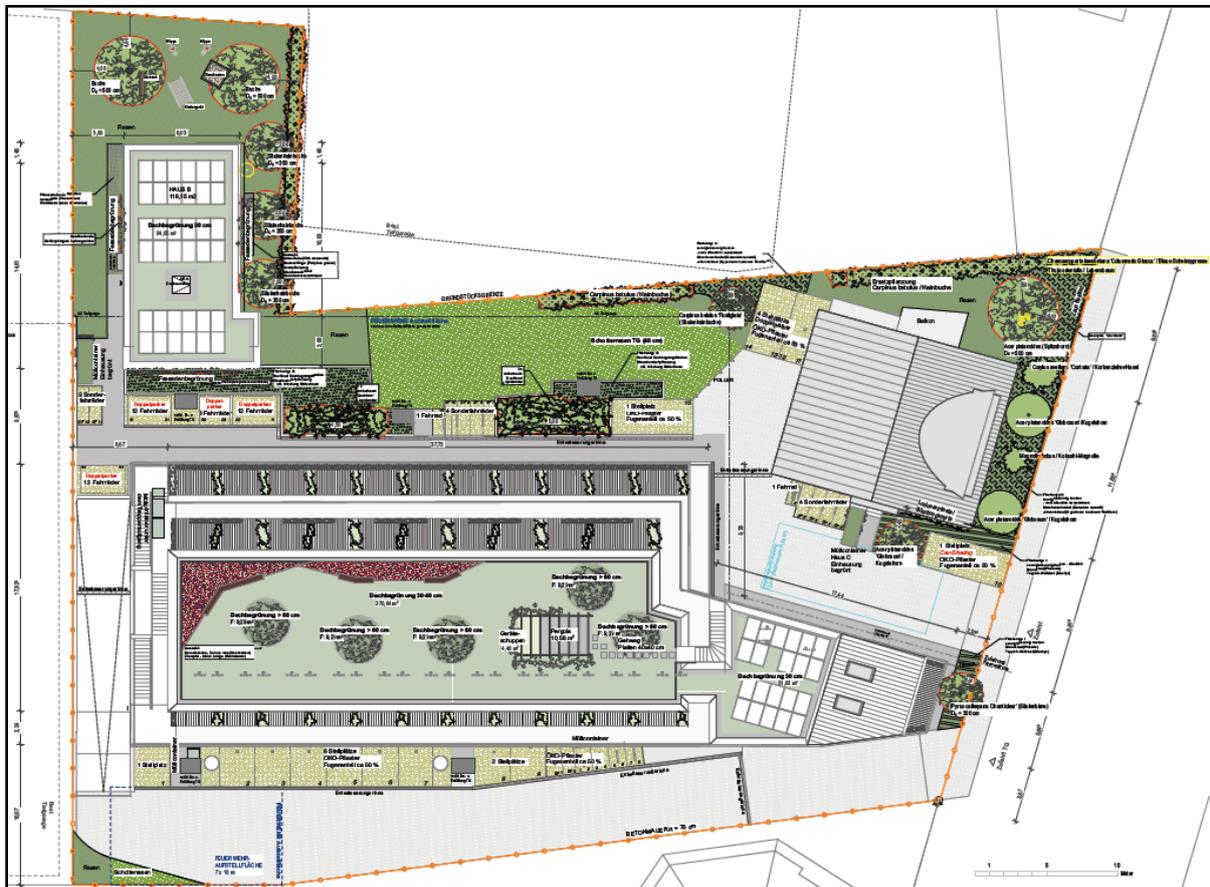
Freiflächenplan mit Dachaufsicht (KONTRASTE GmbH, 22.01.2025).
